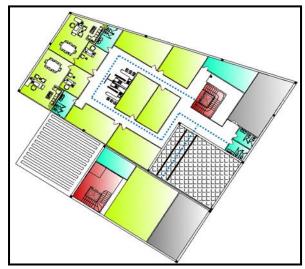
schéma de plan de 8 eme et 9 eme étage.
